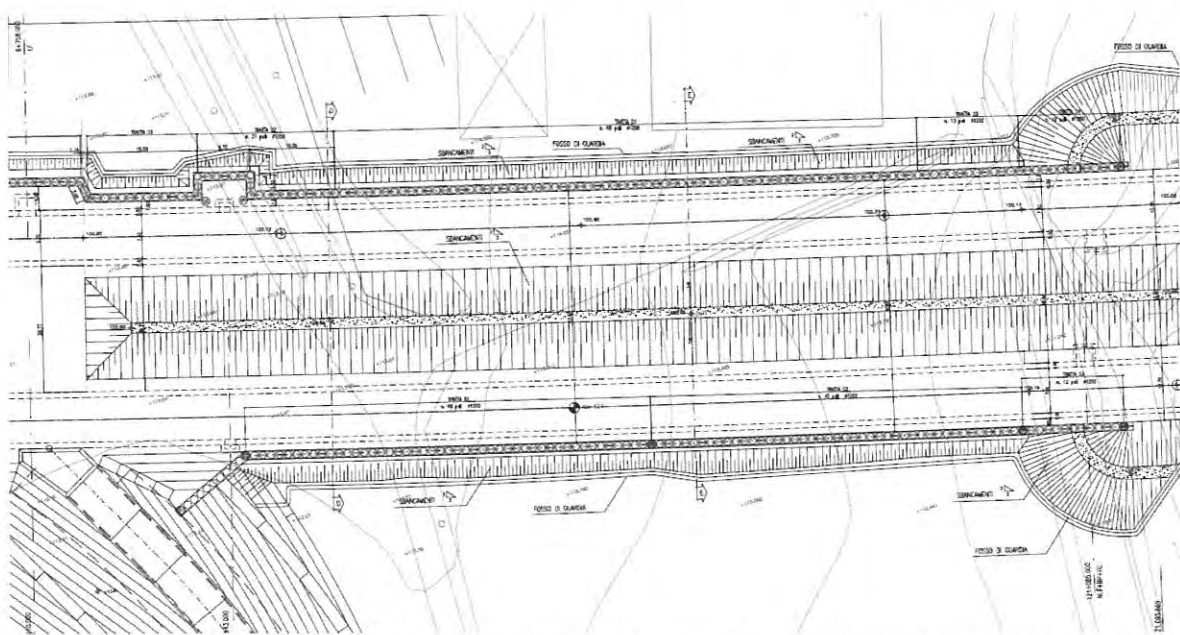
Planimetria di scavo delle opere provvisorie in corrispondenza dell'azienda Serraglio
